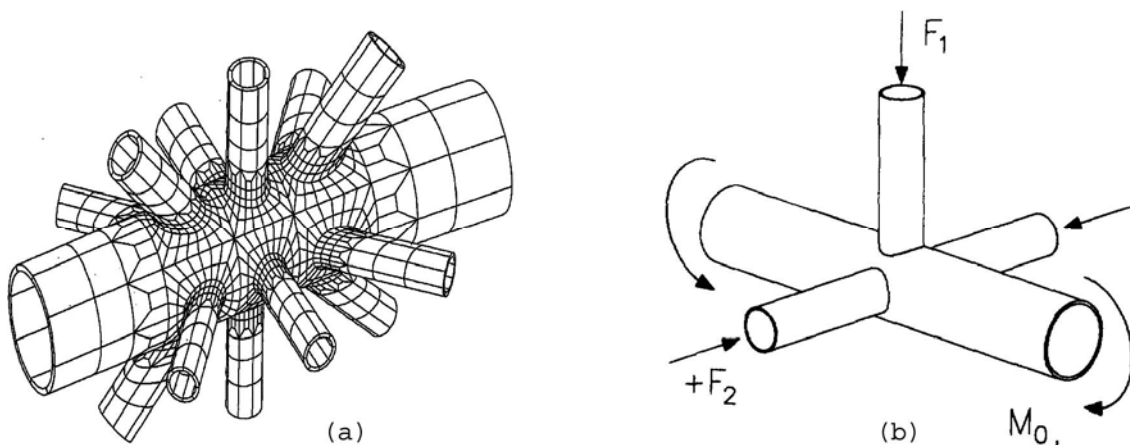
Exemples de jonctions multi-planaires ; (a) jonction formée de 12 entretoises situées dans des plans différents et soudées sur un manchon ; (b) jonction TX.
